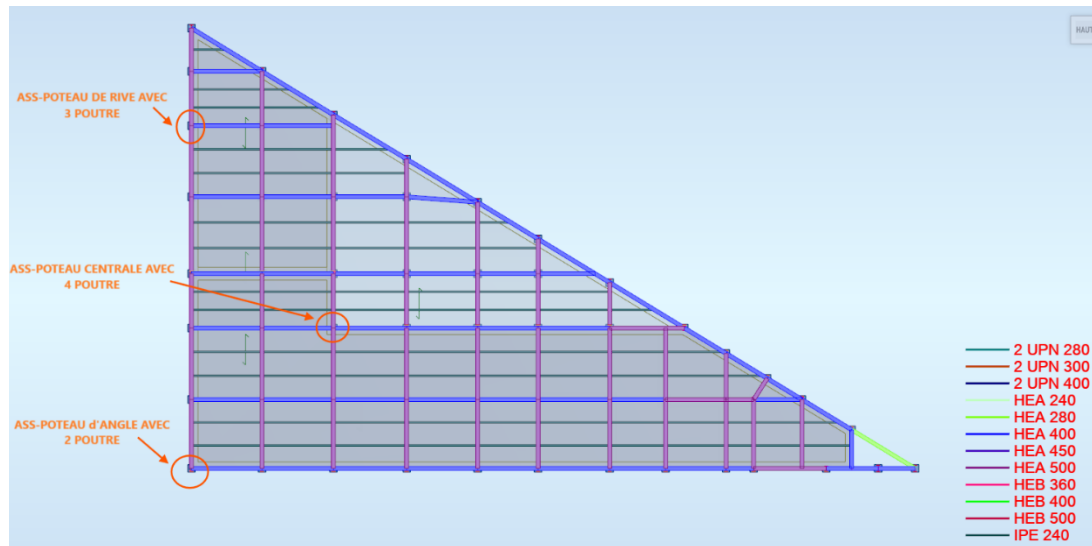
Disposition des différents types Assemblage poteau – poutre (Vue en plan)
